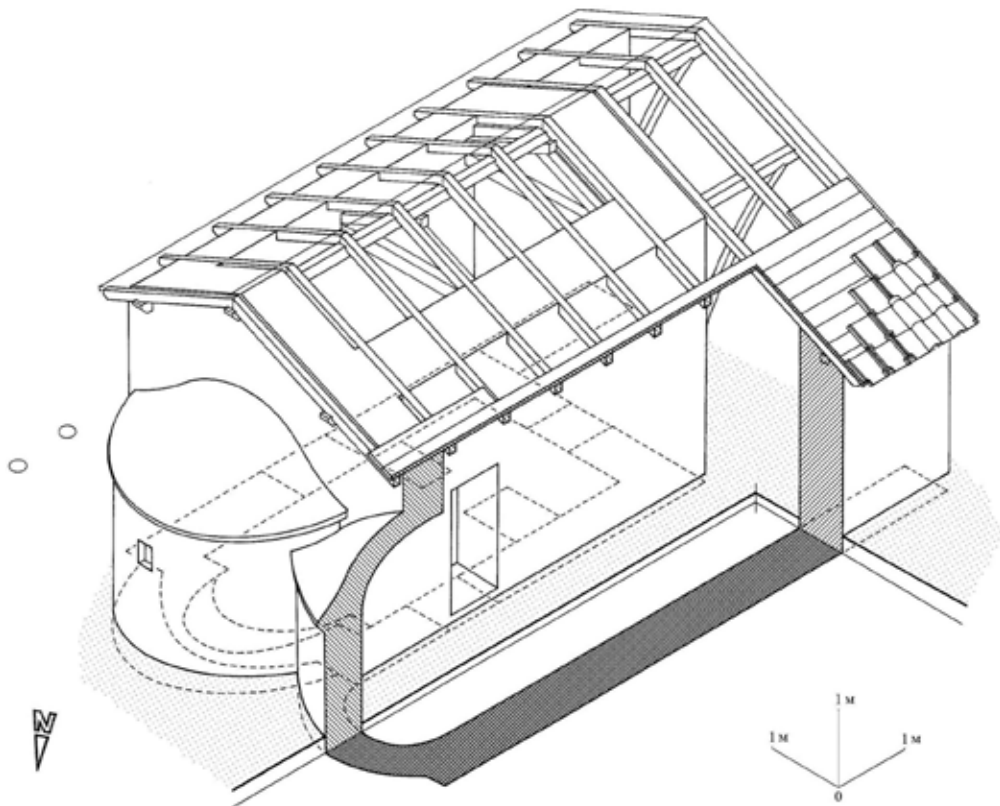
Второй строительный период храма. Реконструкция. Вид с севера.
